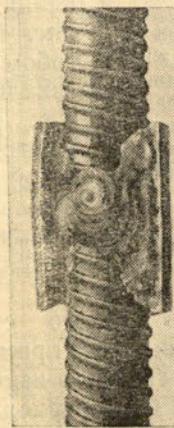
Горизонтальный стык стержней, сваренный ванным способом
